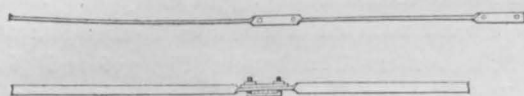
Zum Kreuzverbande unter den Kettensträngen.
